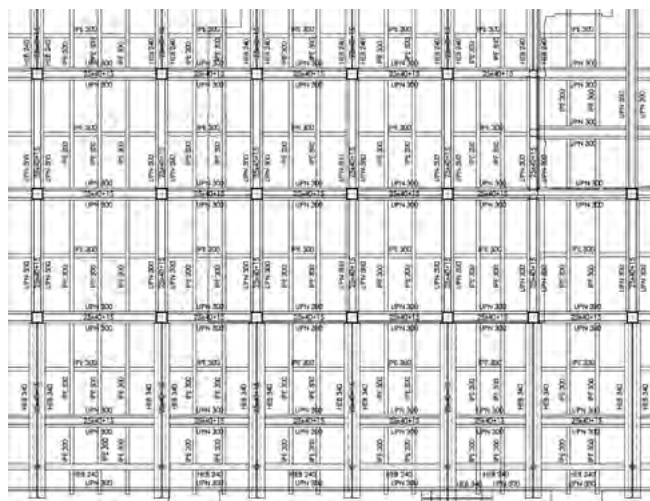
Plano de detalle general del refuerzo inicialmente planteado.
